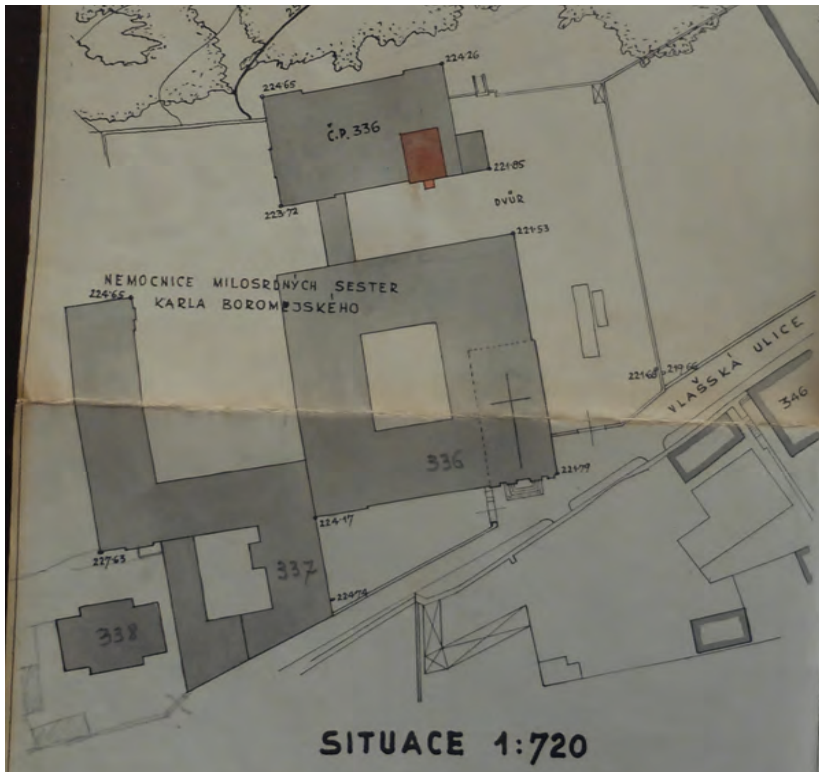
Erweiterung des Heizraumes, Lageplan, Ing. Arch. Jaroslav Čermák, Bau: Architekt und Baumeister Theodor Jan, Originalmaßstab 1:100, 1947
